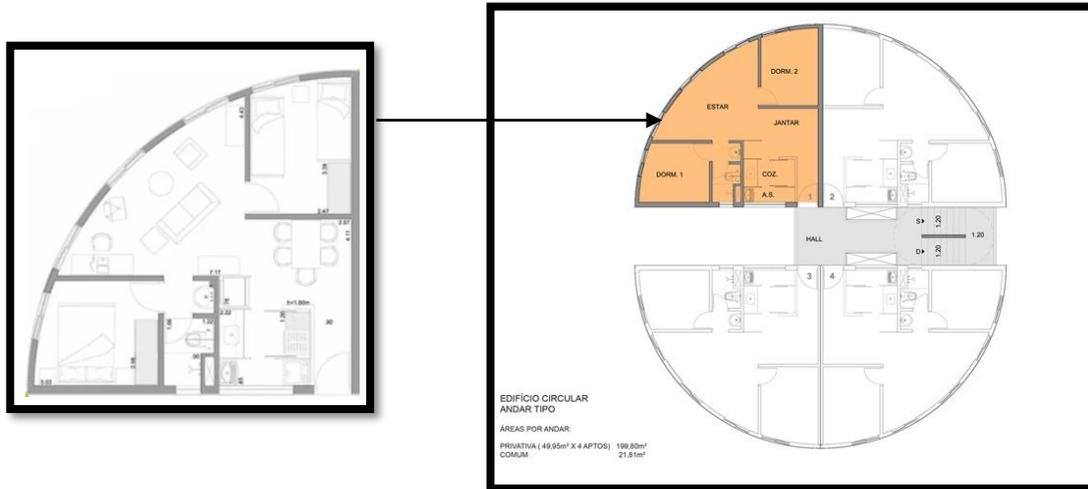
Plan d'étage des blocs d'habitations.(source:archdaily.com).
